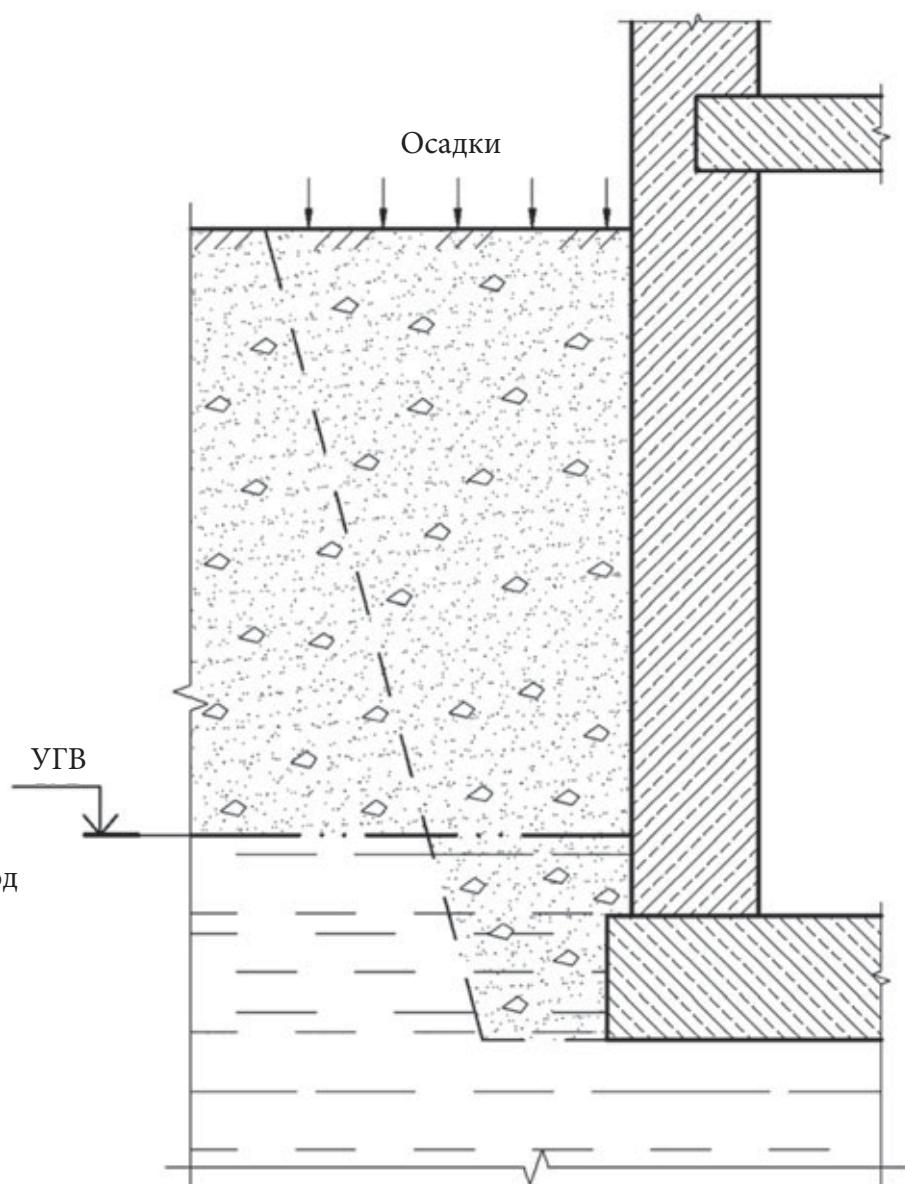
Расчетная схема нагрузки от воздействия грунтовой воды под давлением
